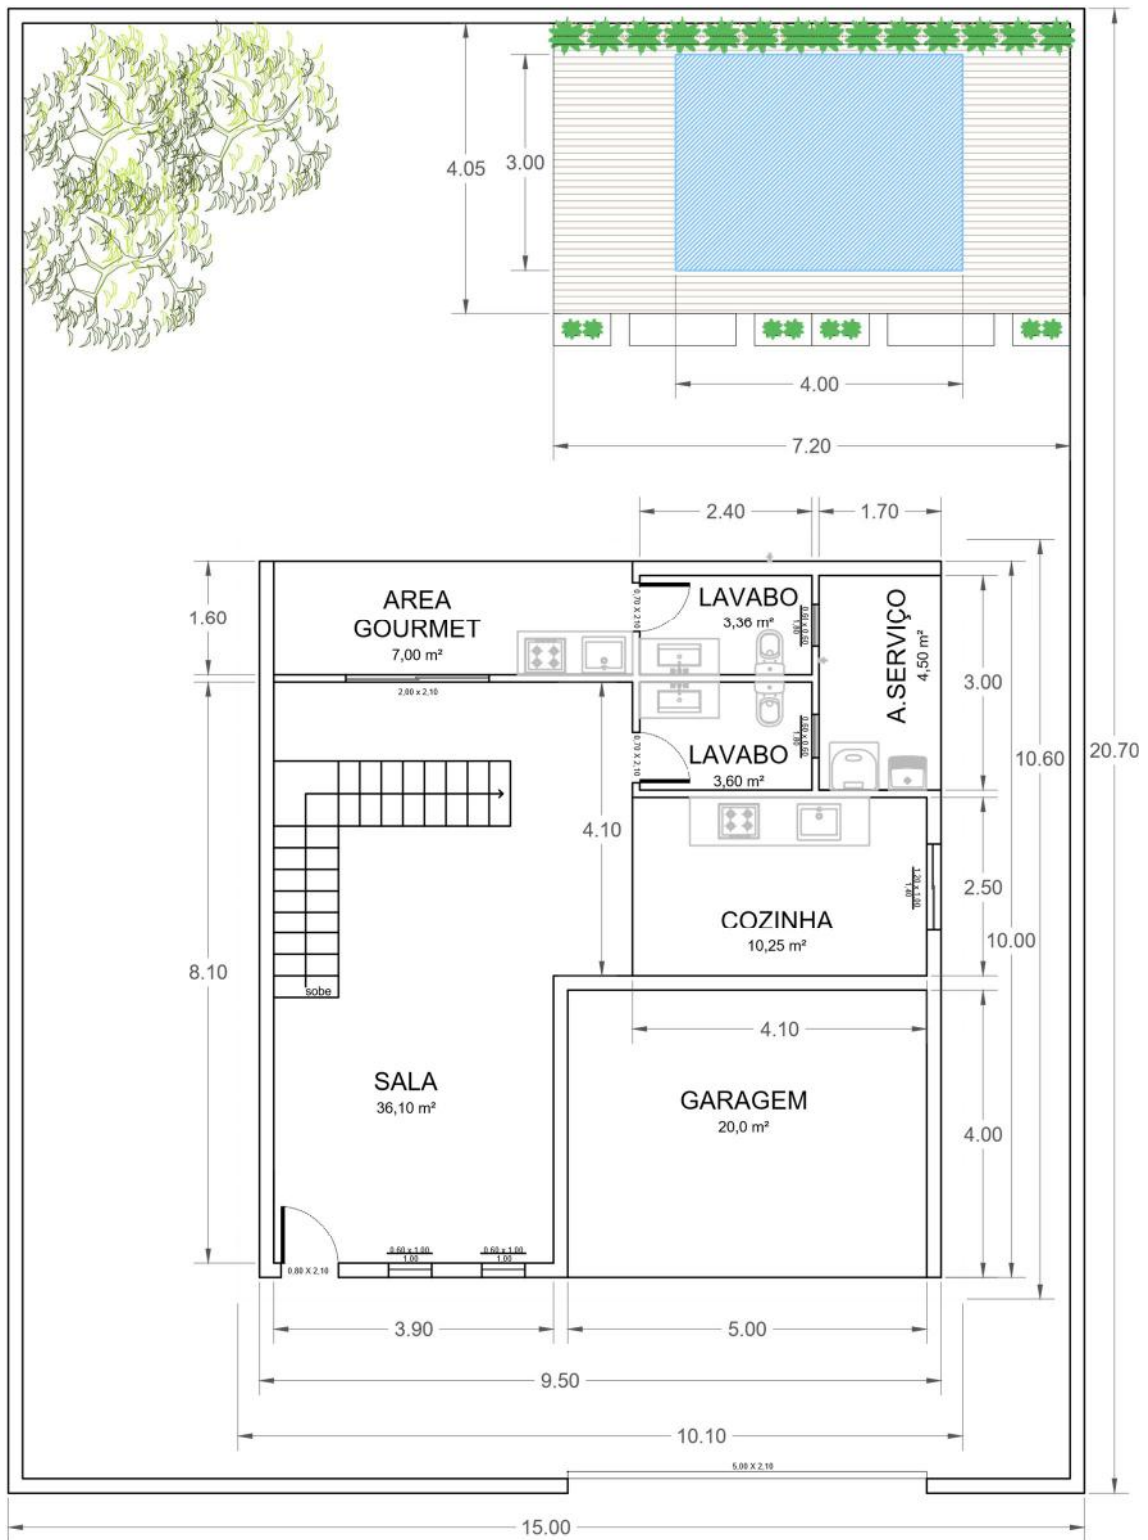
Planta baixa da edificação – Pavimento térreo
